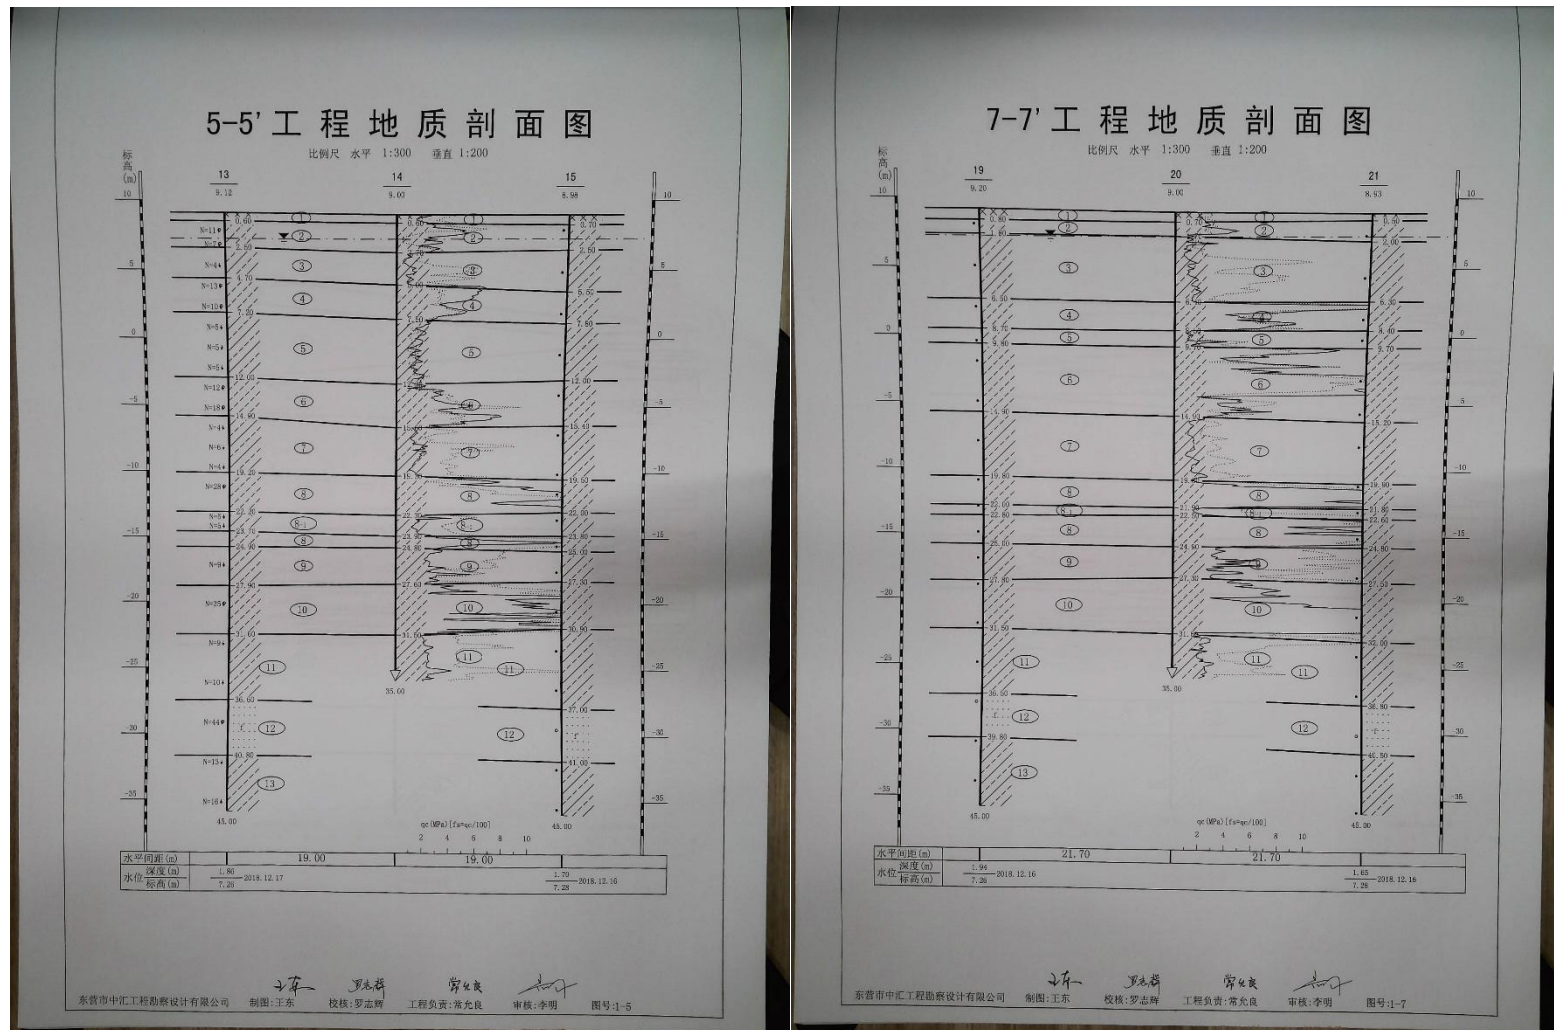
5-5'和 7-7' 工程地质剖面图
